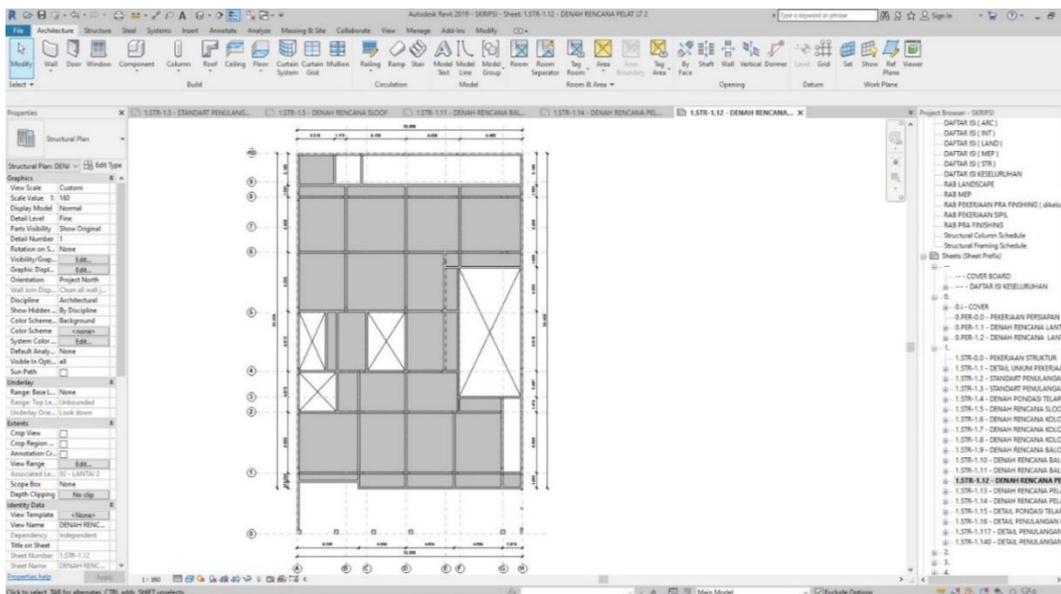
Tampilan Memasukkan Struktur Sloof Kedalam Permodelan
